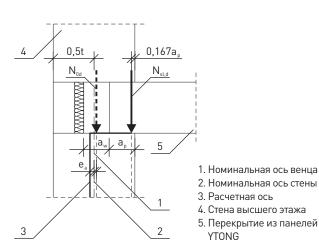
Расчетная схема в случае опоры на кладке панелей перекрытия YTONG
